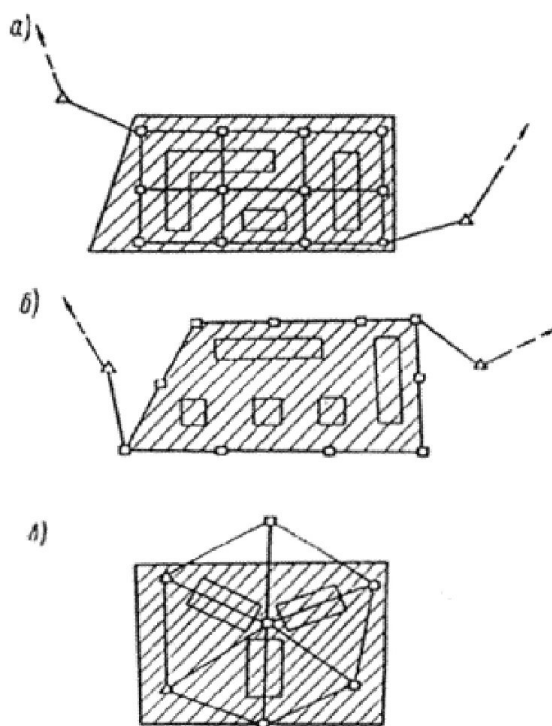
Схемы разбивочной сети строительной площадки в виде:
